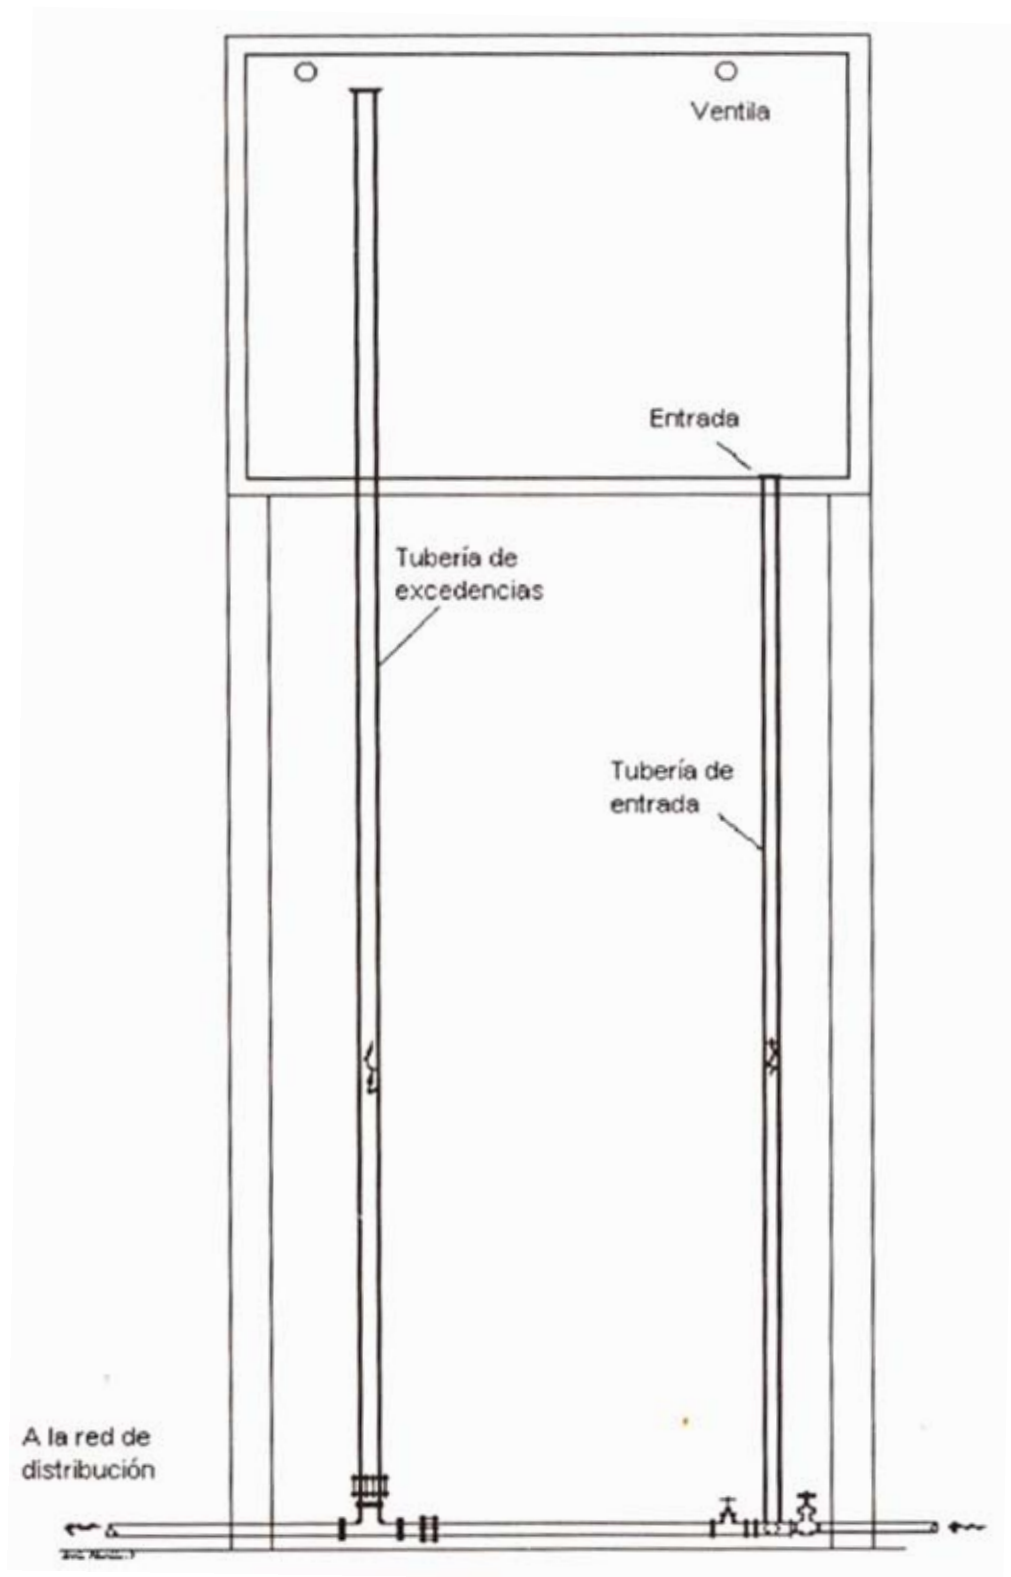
Tanque elevado. Arreglo general de fontanería
